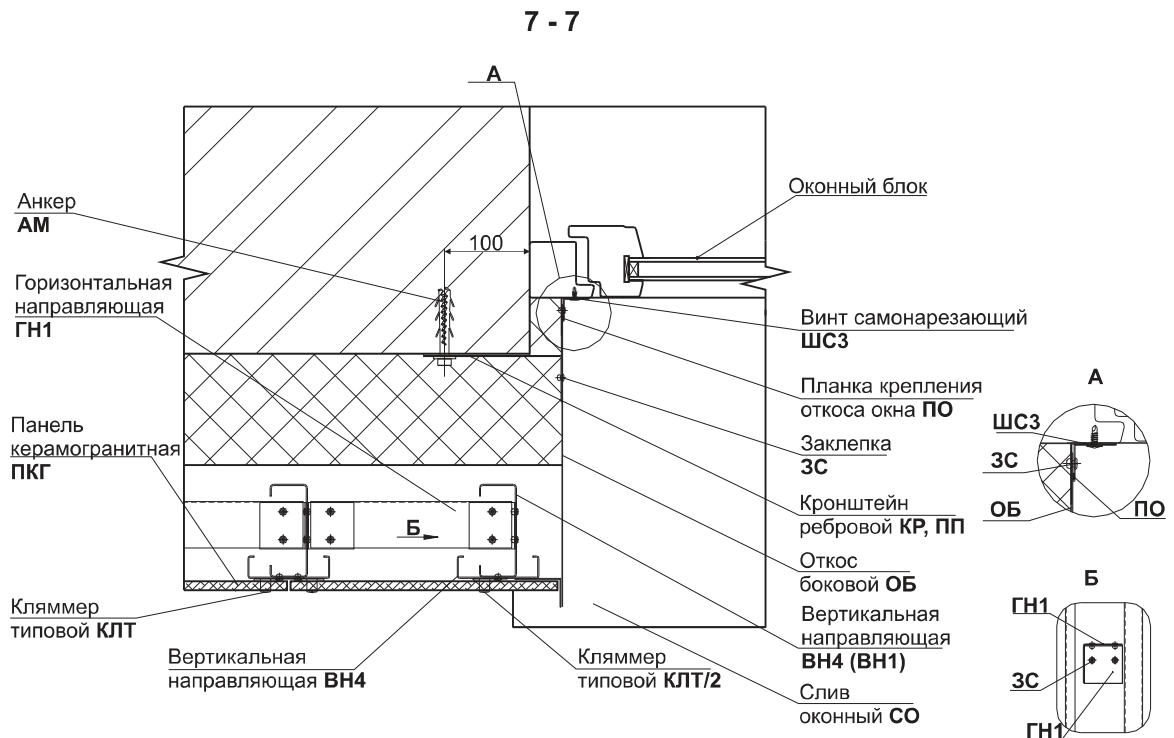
Узел облицовки бокового откоса при креплении системы к междуэтажному перекрытию. Вариант 2.
